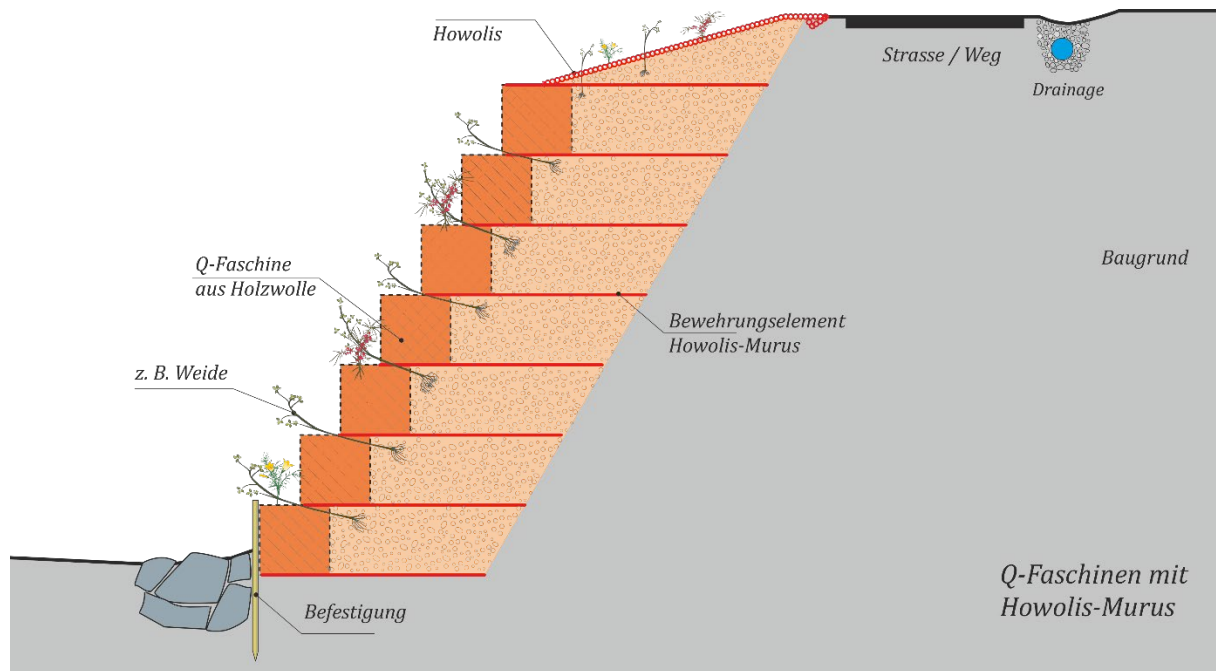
Systemaufbau MURUS mit Holzwolle-Faschinen
